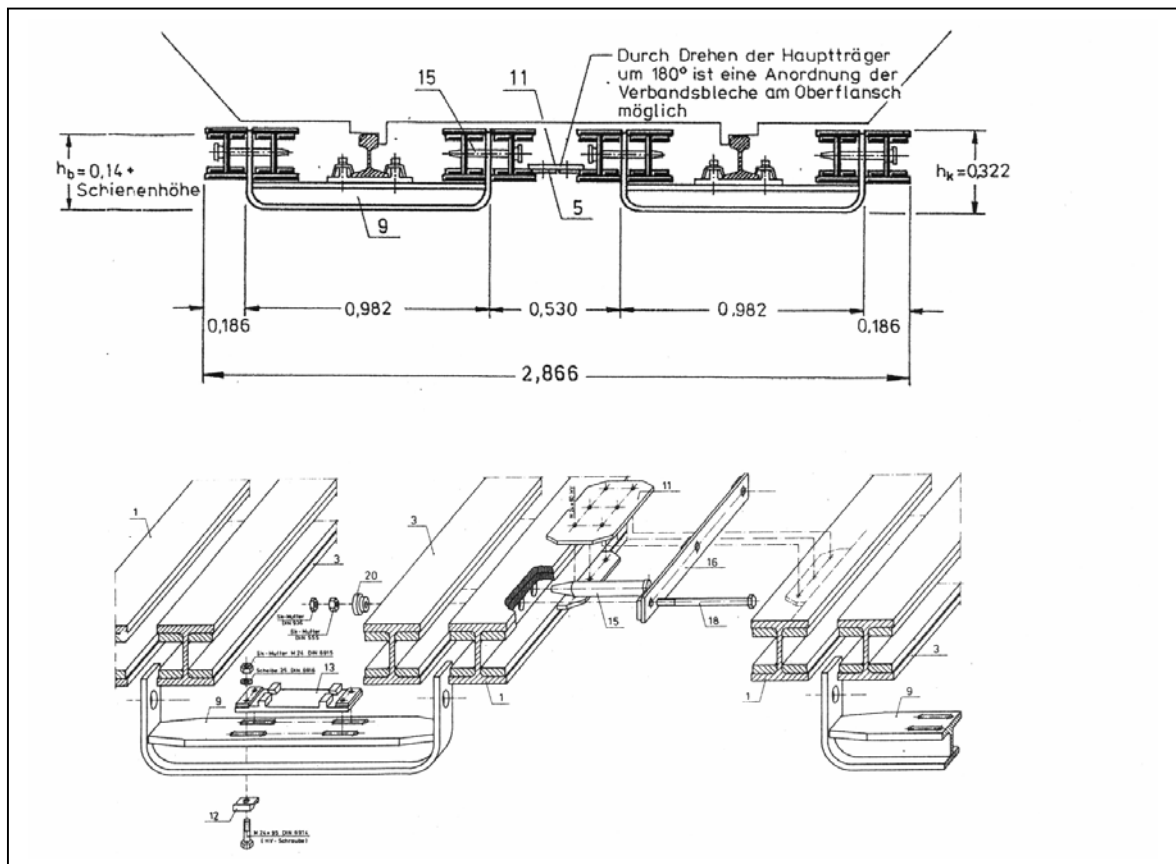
Schnitt und Schema einer Kleinhilfsbrücke /2/
